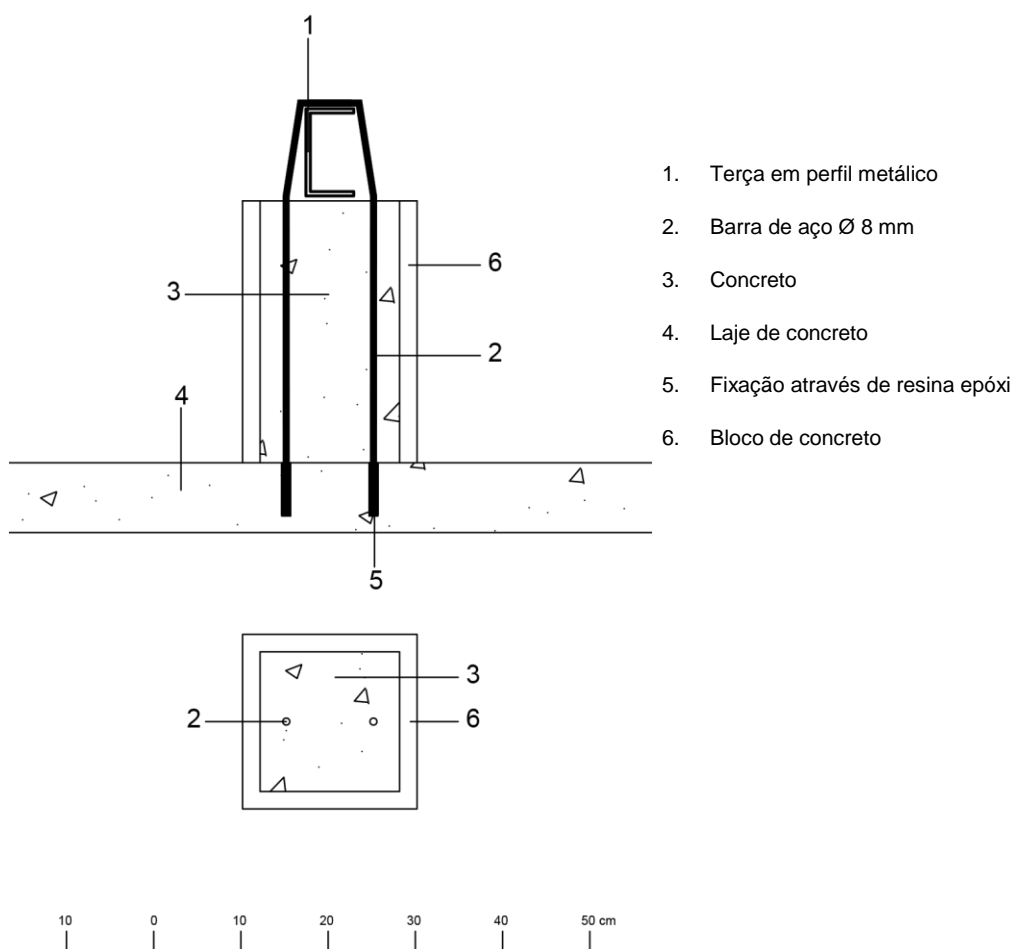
Detalhe do pilarete em alvenaria (Fonte: SEF)
